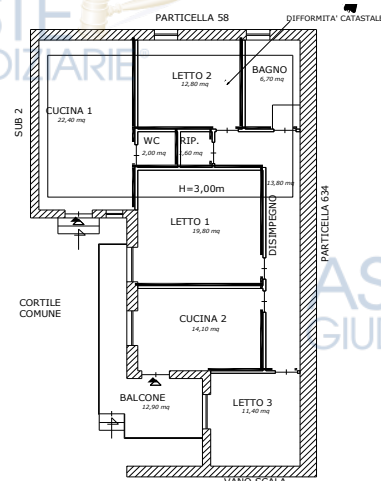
planimetria delle difformità catastali dell'appartamento al piano rialzato
